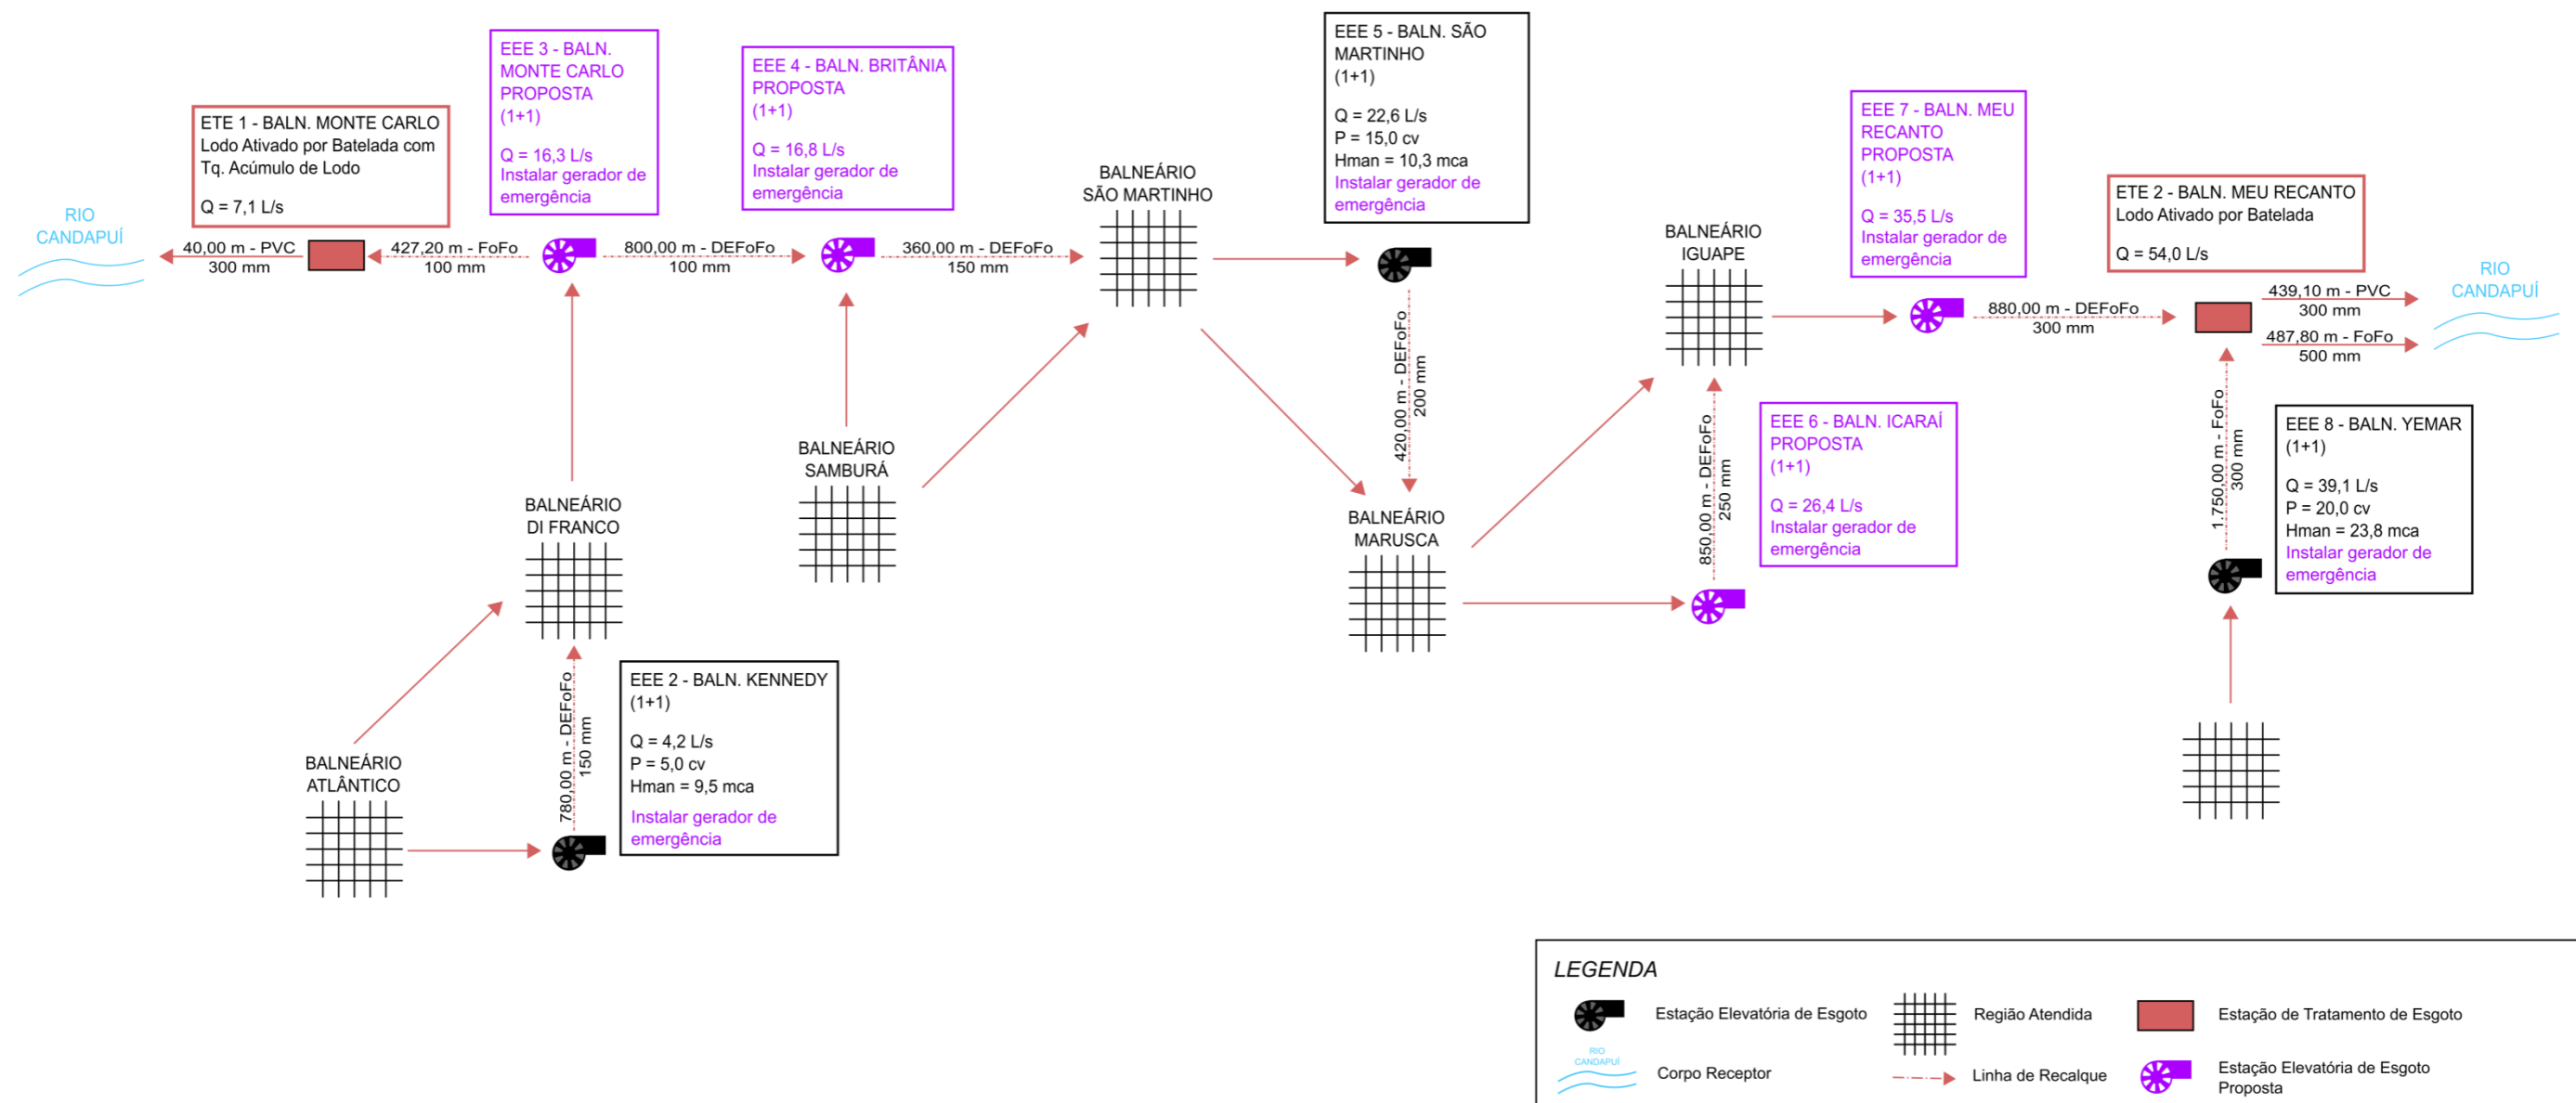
Croqui do sistema de esgotamento sanitário proposto para a Sede
